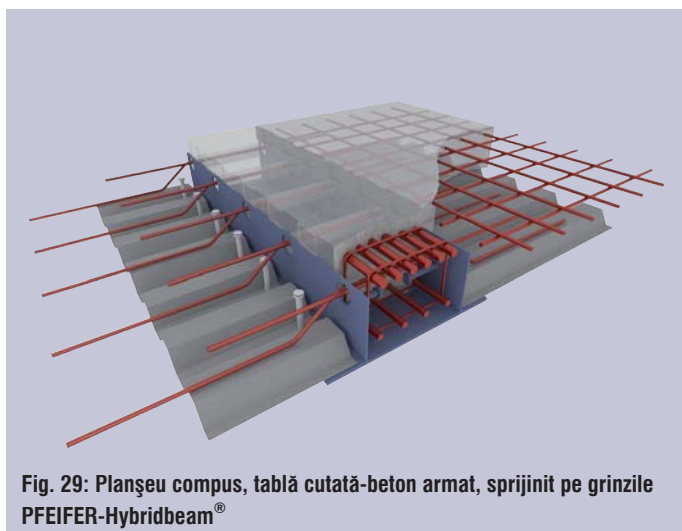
Planșeu compus, tablă cutată-beton armat, sprijinit pe grinzile PFEIFER-Hybridbeam®
